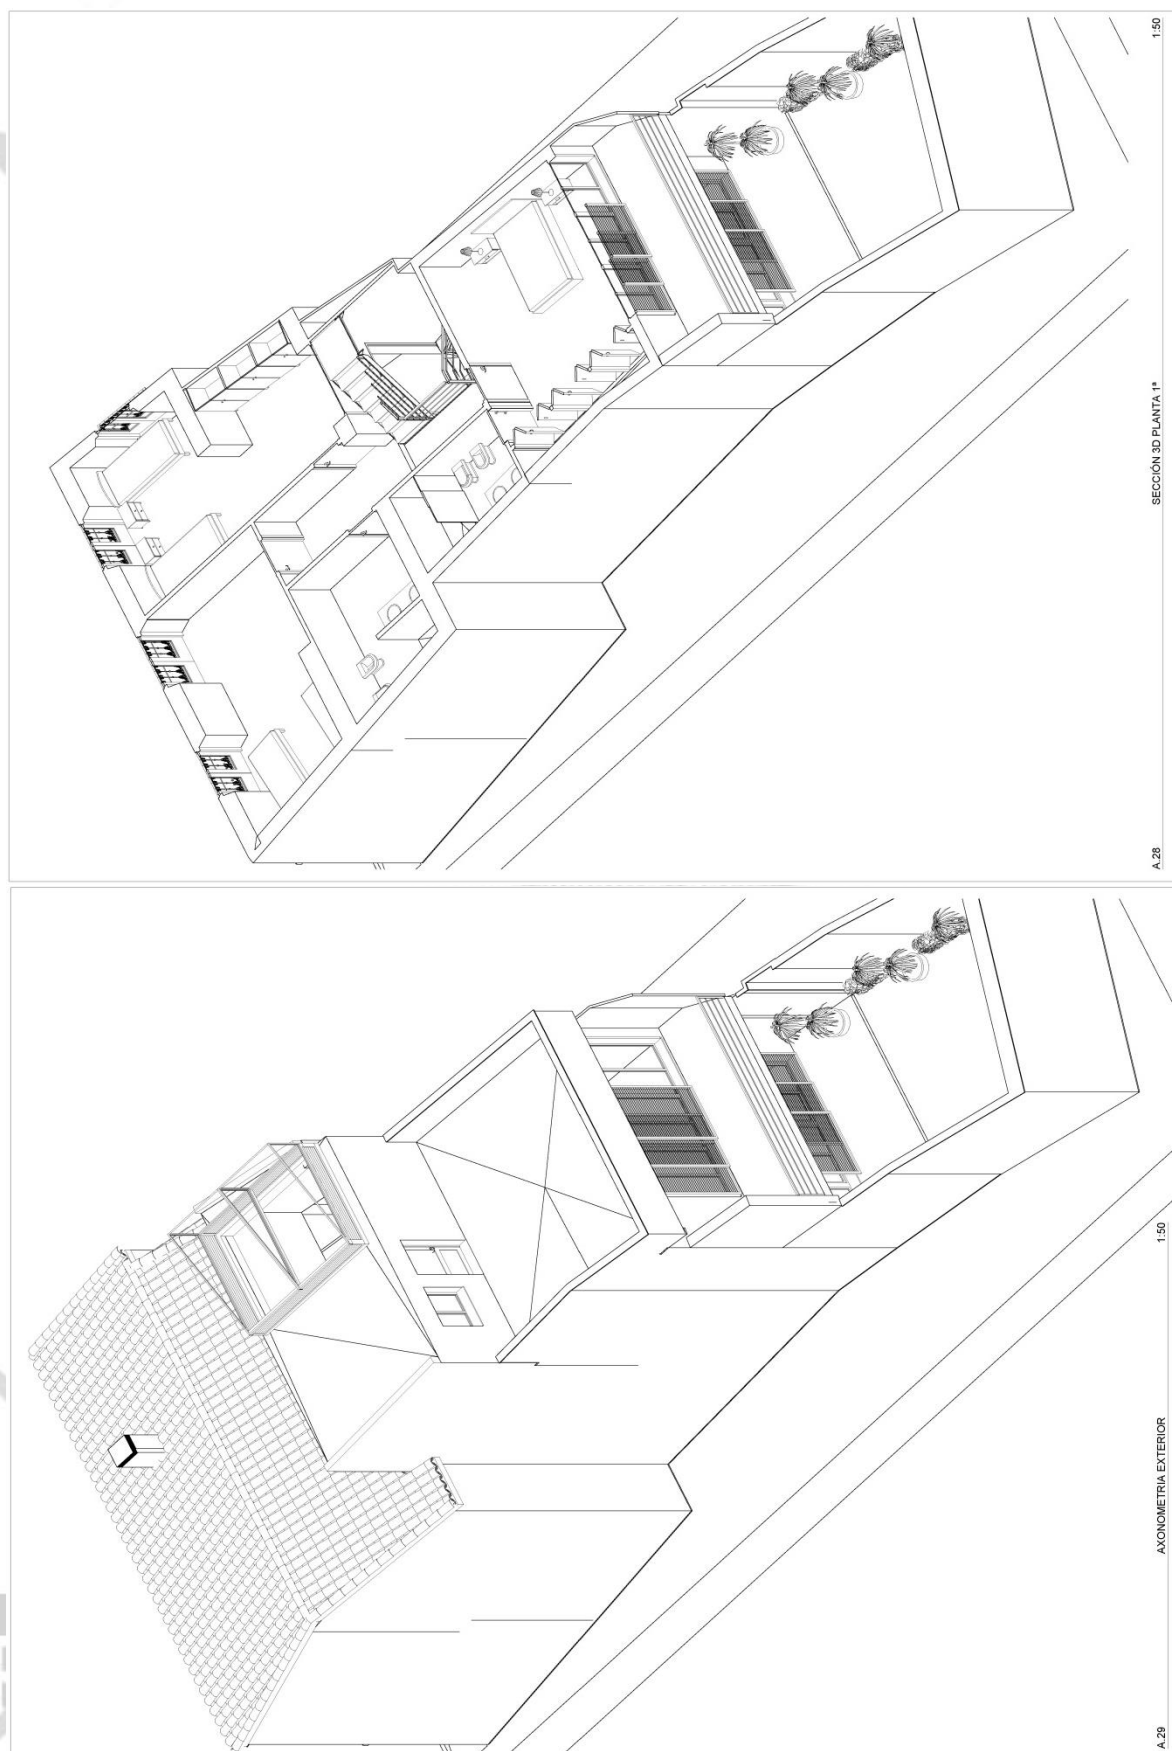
Proyecto de rehabilitación de vivienda: a) Estado Actual Planta Baja, b) Estado Reformado Planta Baja, c) Sección 3D Planta Baja Reformada (página anterior); d) Sección 3D Planta primera Reformada; e) Vista 3D de la Vivienda Completa Reformada. Elaborado por ArchiCAD por la gestión de capas. Fuente: autor. 2011.
